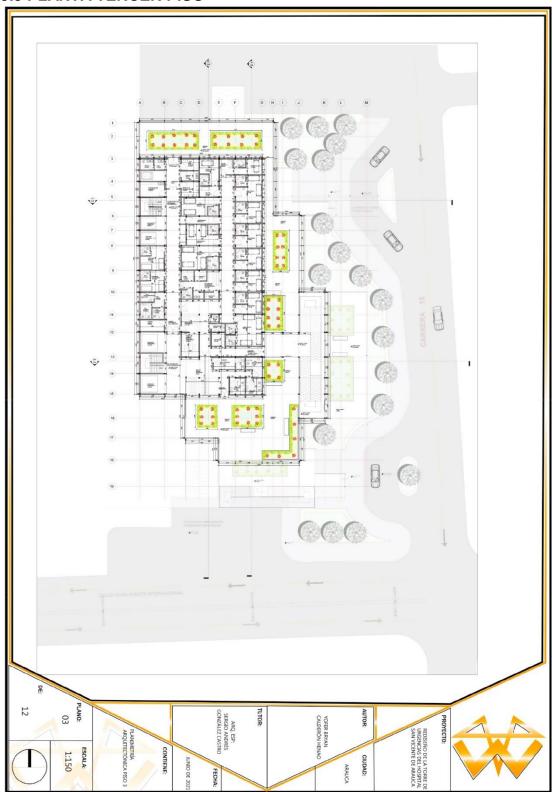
Planta tercer piso. Fuente: elaboración propia
